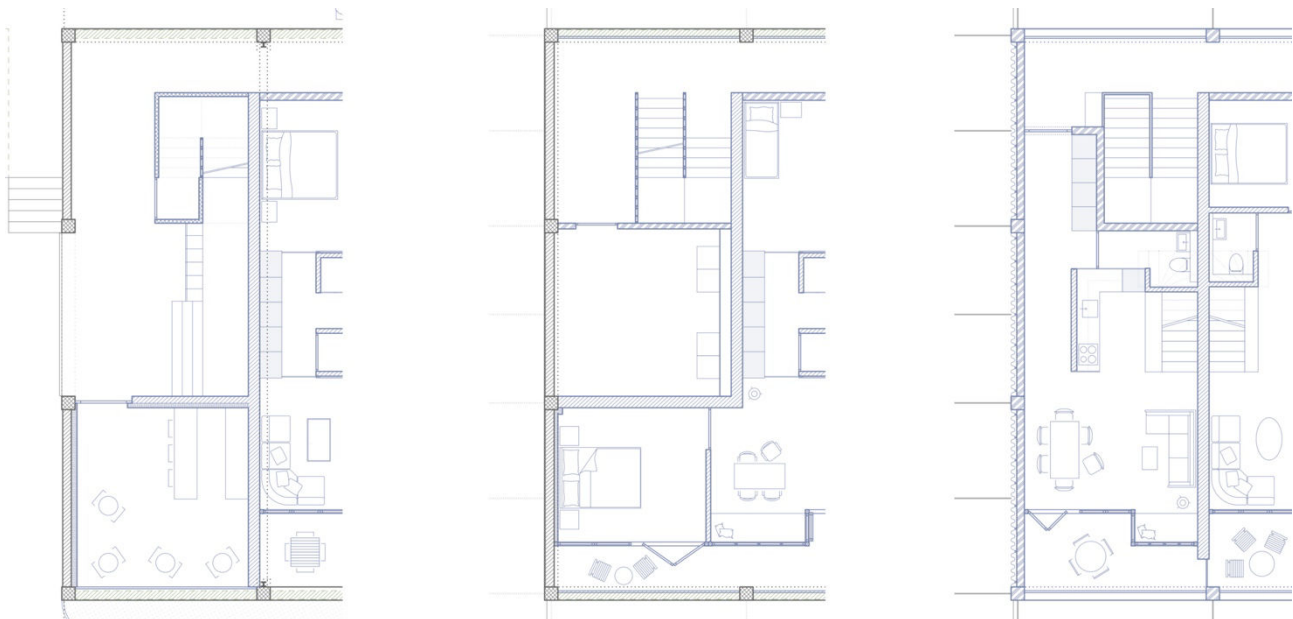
Grundriss Hapterschliessung von links nach rechts EG, 1. OG und 2. OG, Schlussabgabe am 12.01.2024
